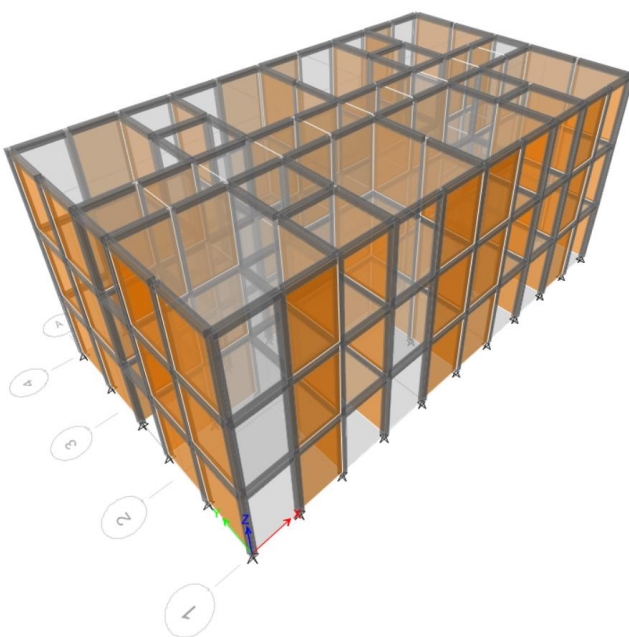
Distribución mampostería confinada del sistema estructural Nivel 1 -3.
